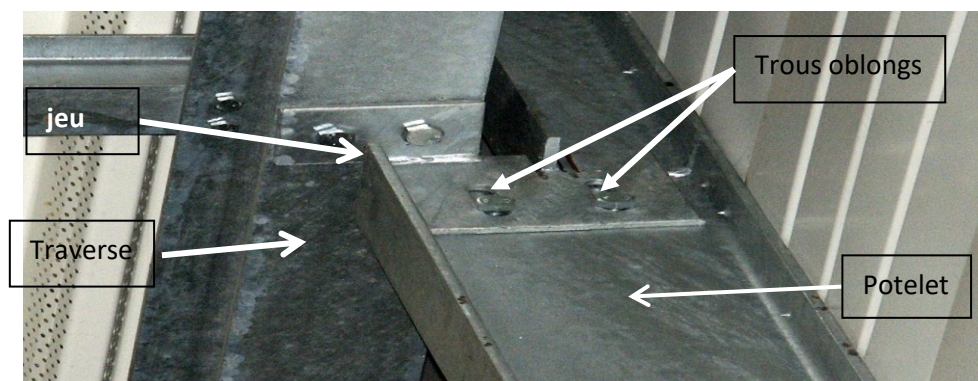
dispositif d'appui glissant du potelet sur la poutre auvent (la traverse en fait partie)
